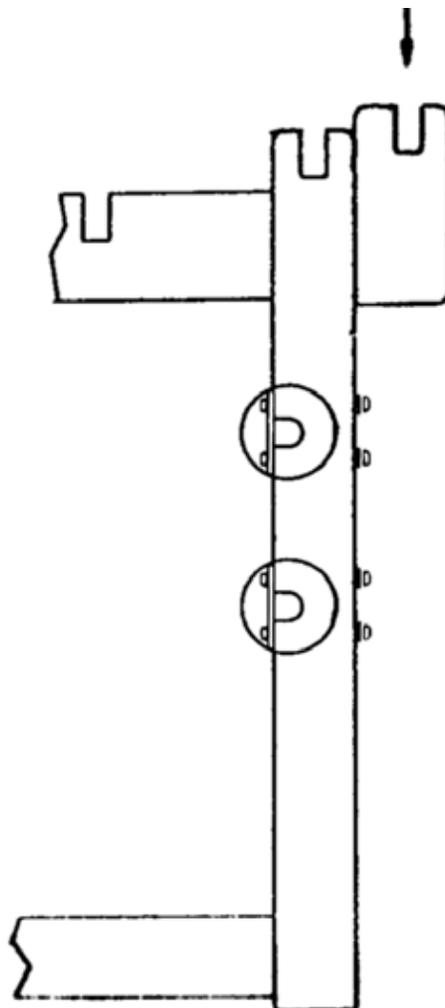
Ubicaciones de la viga mamaria y la viga de separación
